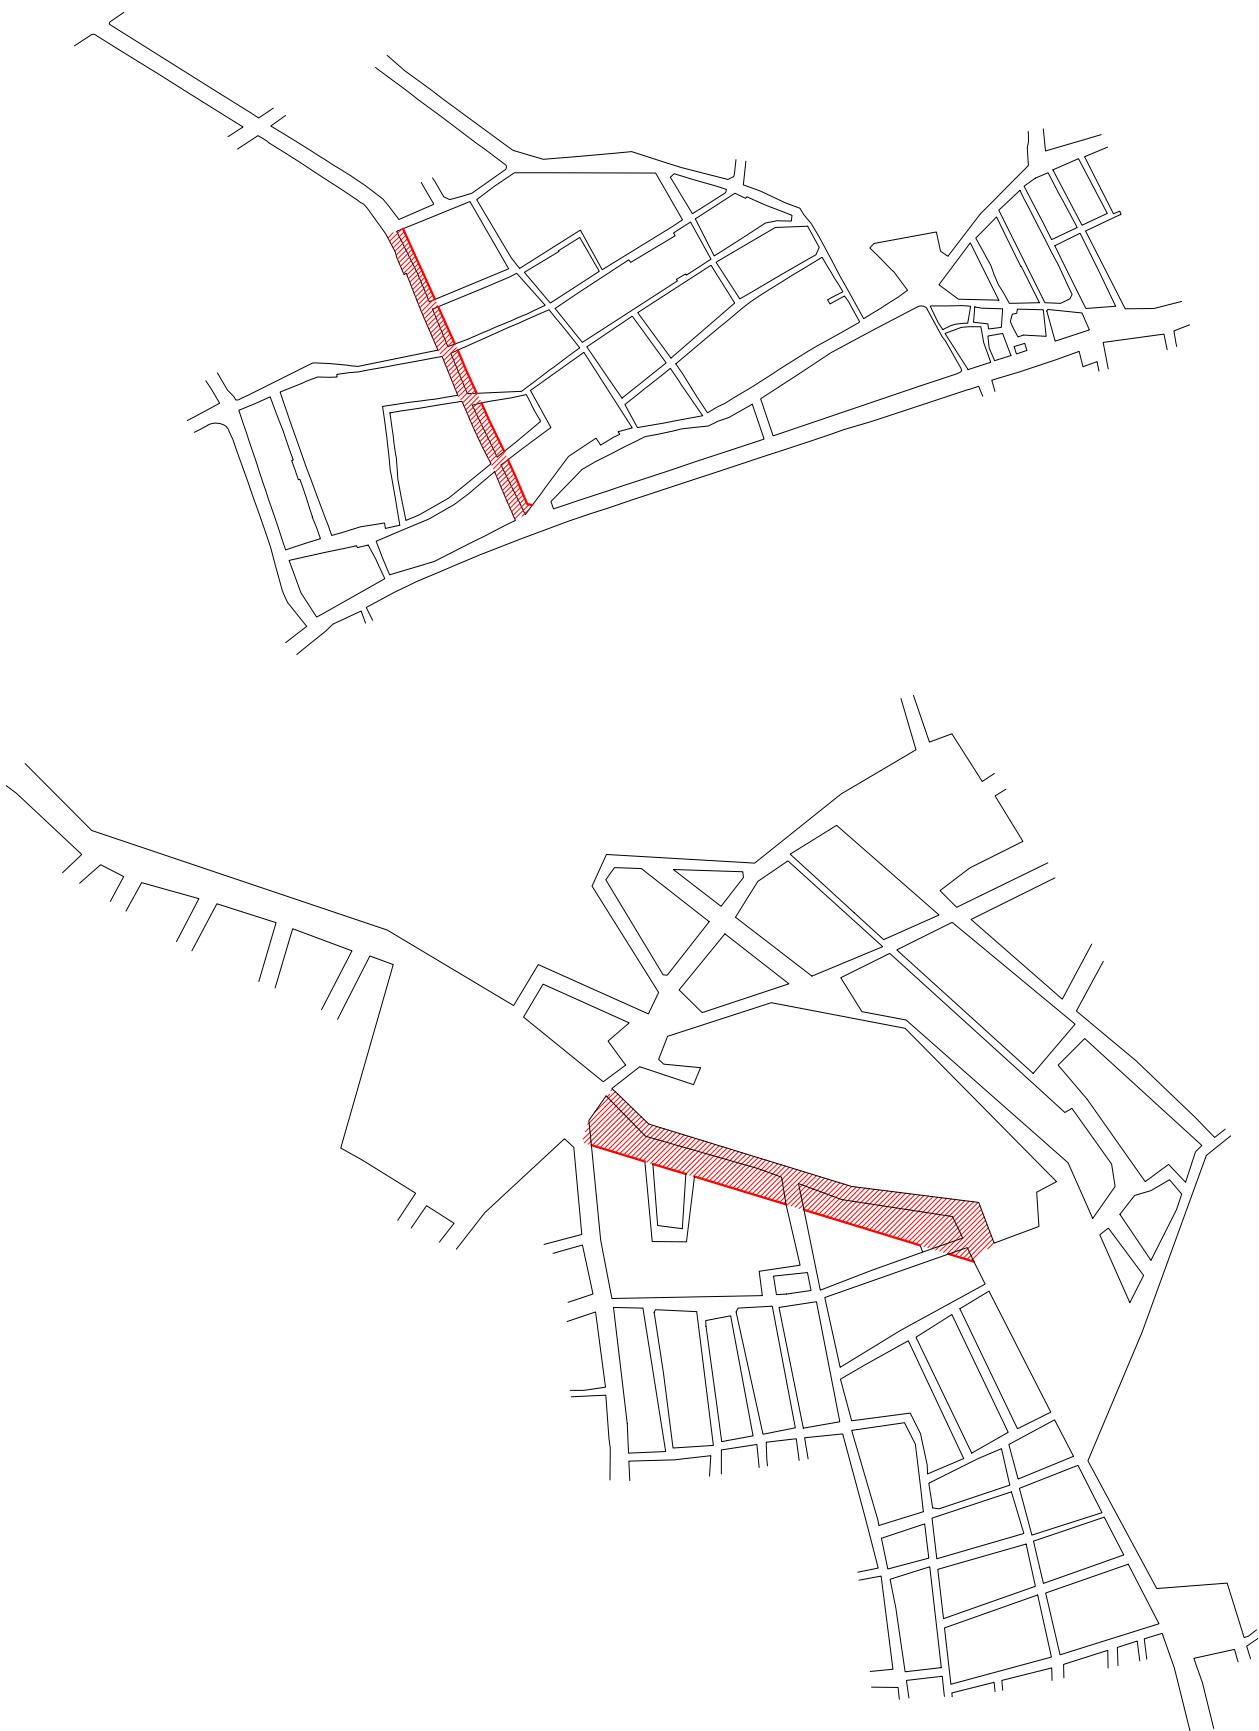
• Alargamento da Rua das Trinas sobre o traçado urbano preexistente. Planta (1:5.000)
